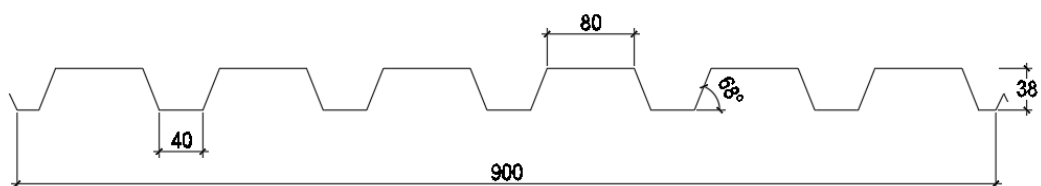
Dimensiones del Perfil AD-900 (mm).
